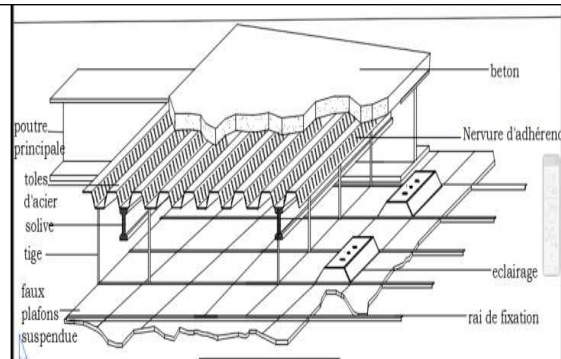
detail des planchers collaborantssource : [www.detailconstructif.cype.com](http://www.detailconstructif.cype.com)
